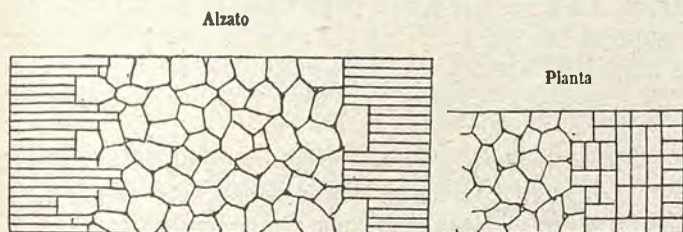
Muratura di pietra greggia con spalle di mattoni.
